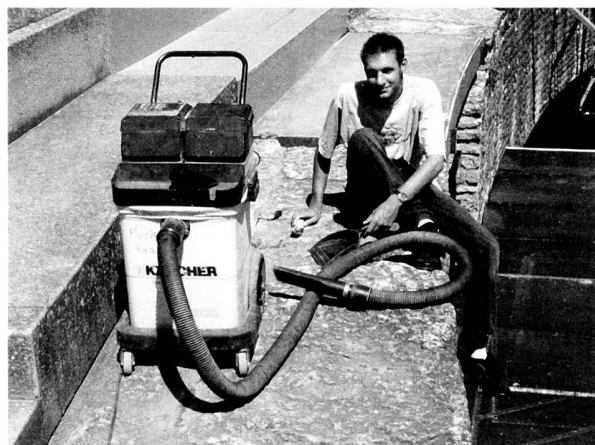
Travaux de rejointoiement du dallage du mur de podium de l'amphithéâtre. Photo. MRA.
